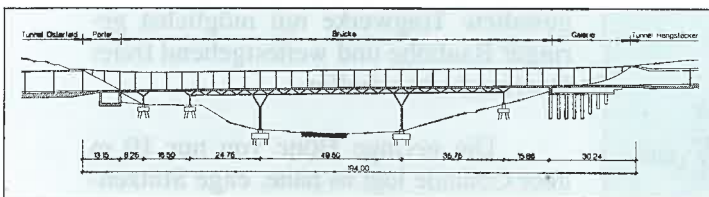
Straßenbrücke über das Neesenbachtal in Stuttgart, 1999: Konstruktionszeichnung
